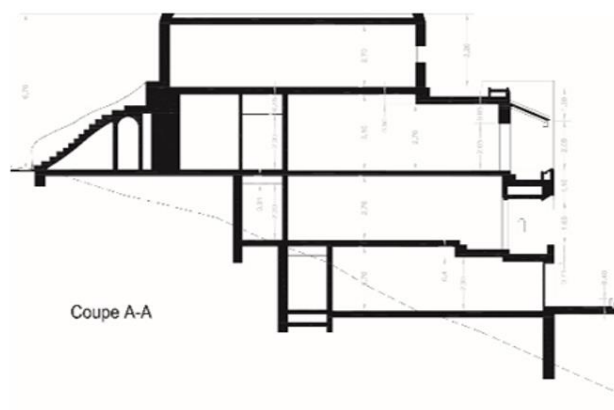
Coupe sur l'hôtel El Mountazah © l'auteure Gourara, extrait du plan RdC
